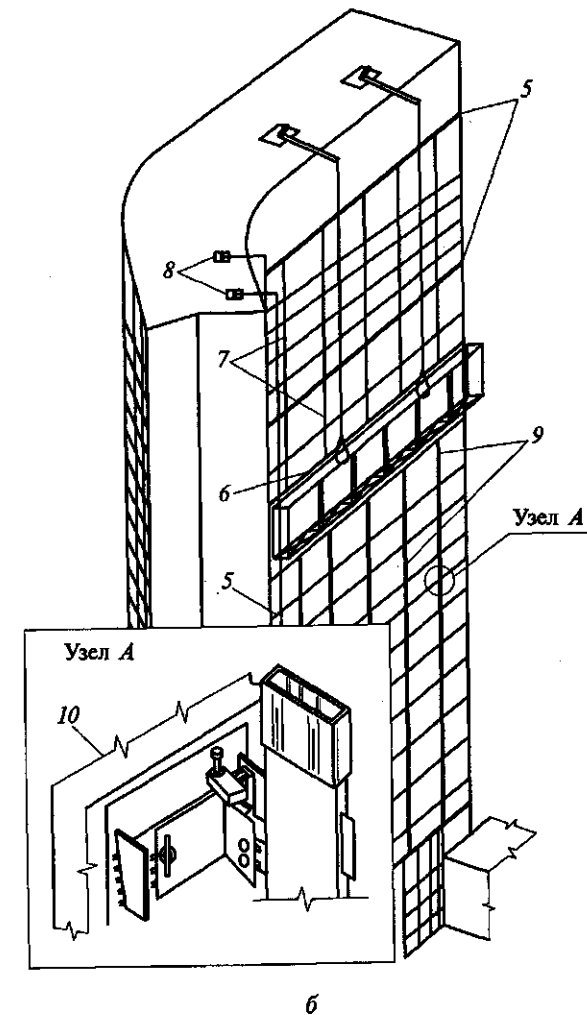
Схемы монтажа конструкций высотного здания:
